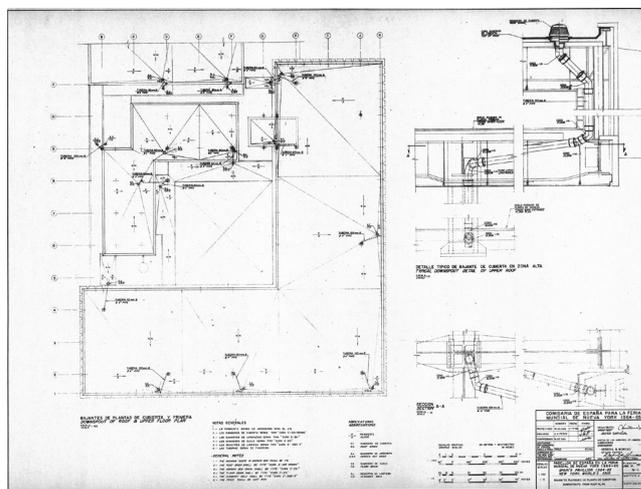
Plano de bajantes pluviales de la planta de cubiertas (Archivo Heredia & Moreno S.A.). Obsérvese el detalle del trazado de la bajante pluvial en relación a los cerramientos y la estructura metálica.
